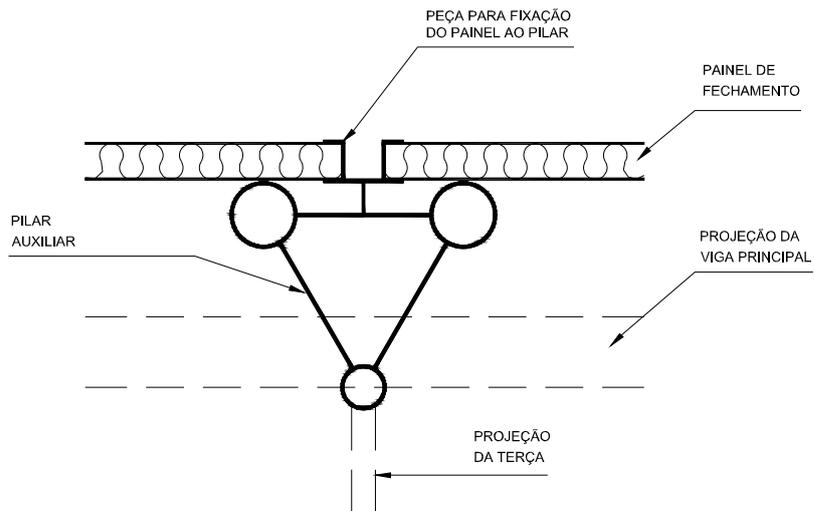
Detalhe da fixação dos painéis no pilar tipo 2.
